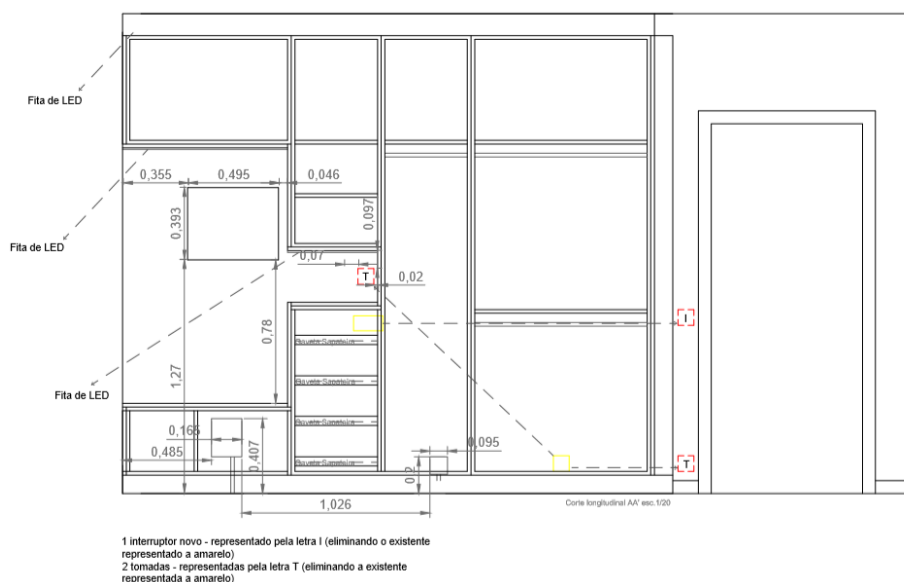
Desenho Técnico Armário - Parte elétrica. Escala 1/20. Fonte: autor
